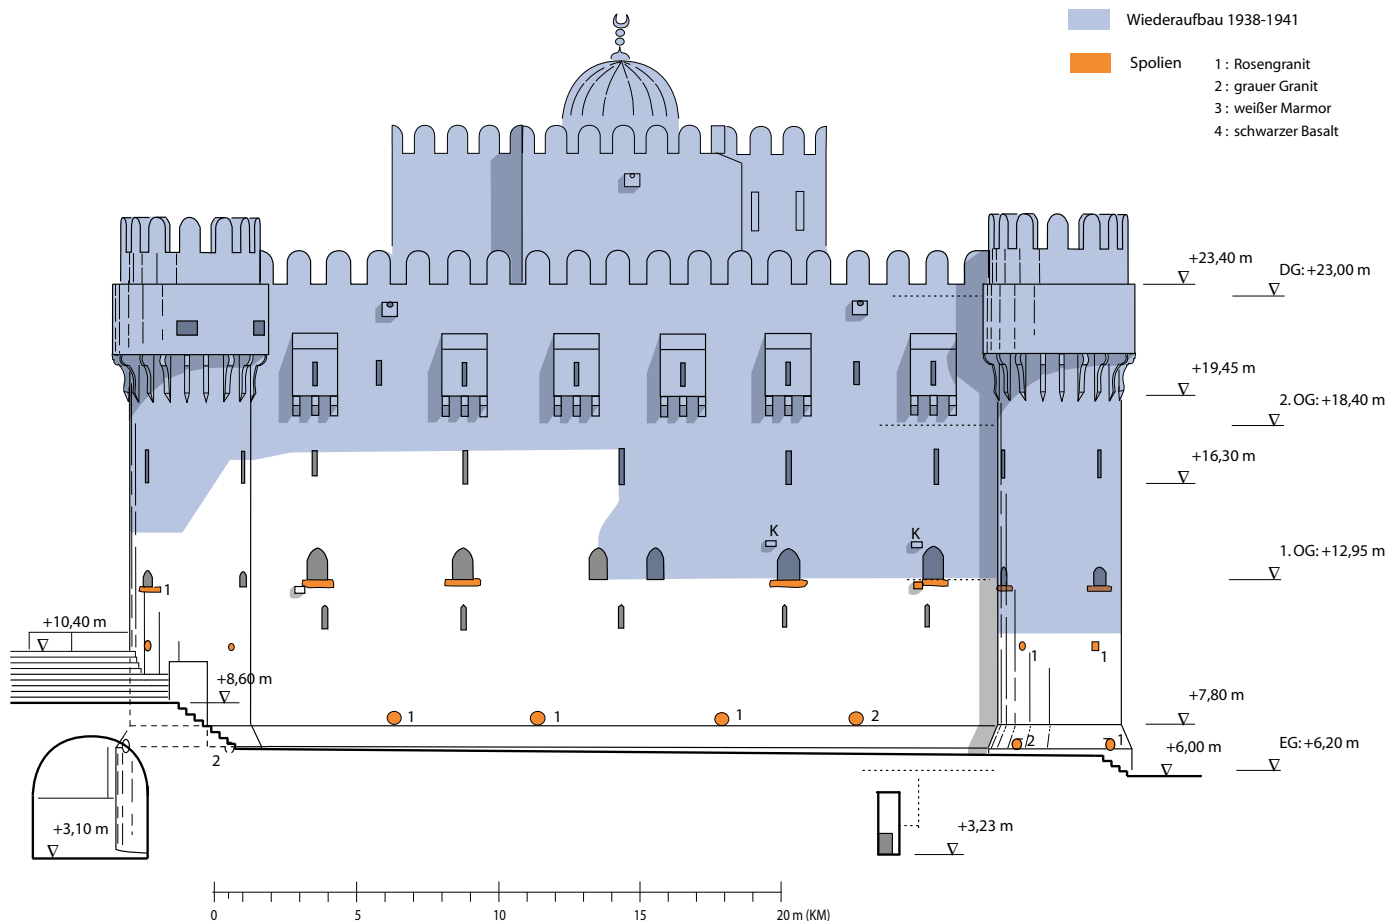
Hauptturm: wiederaufgebaute Nordfassade.
